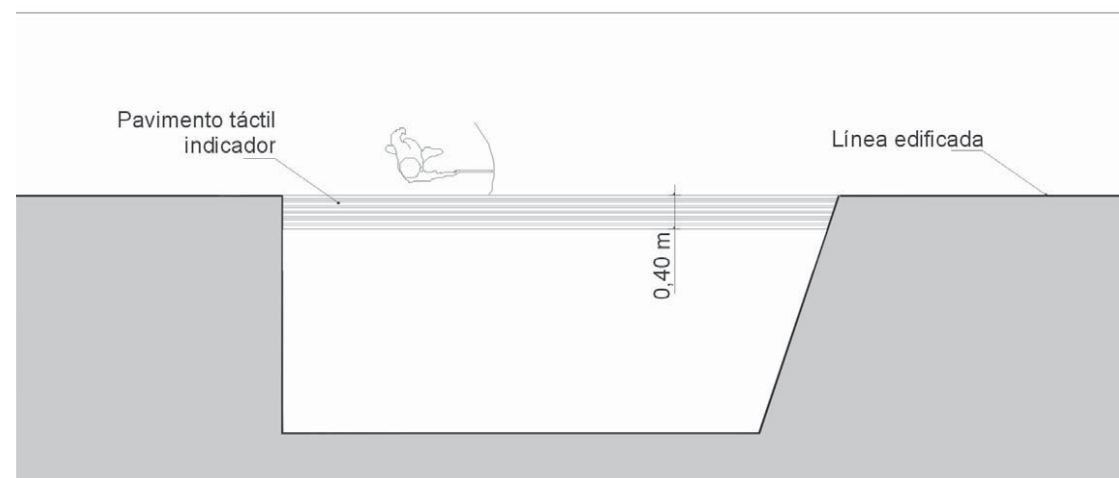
Franja de pavimento táctil indicador direccional que da continuidad a la línea edificada
